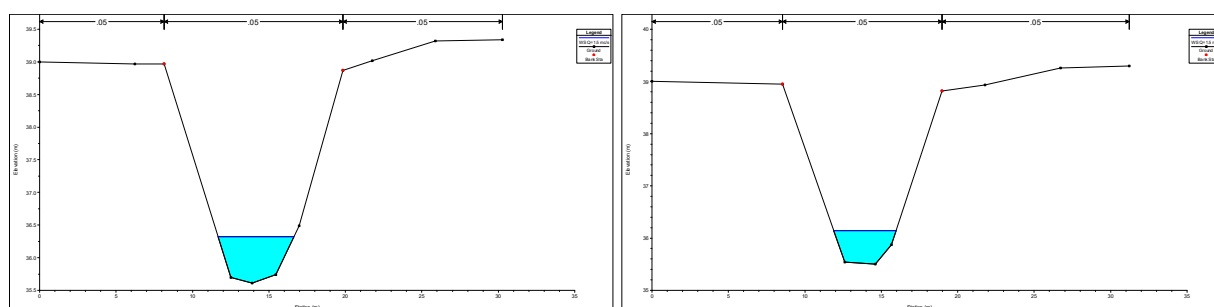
Sezione 26 (a sinistra) e sezione 25 (a destra), stato di progetto
